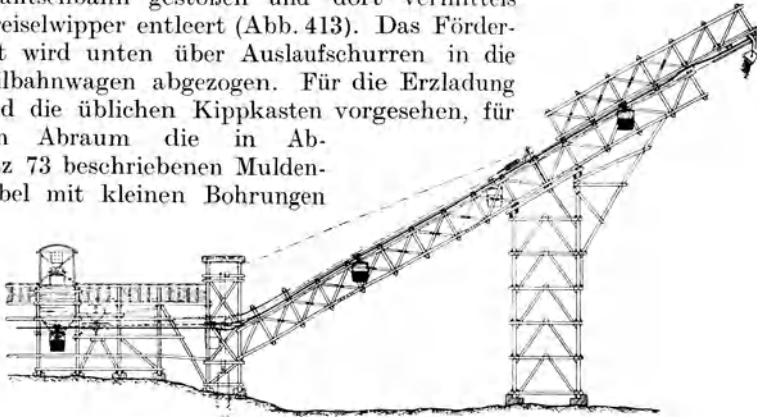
Schrägbrücke in Holz (Kaiser & Co.).
